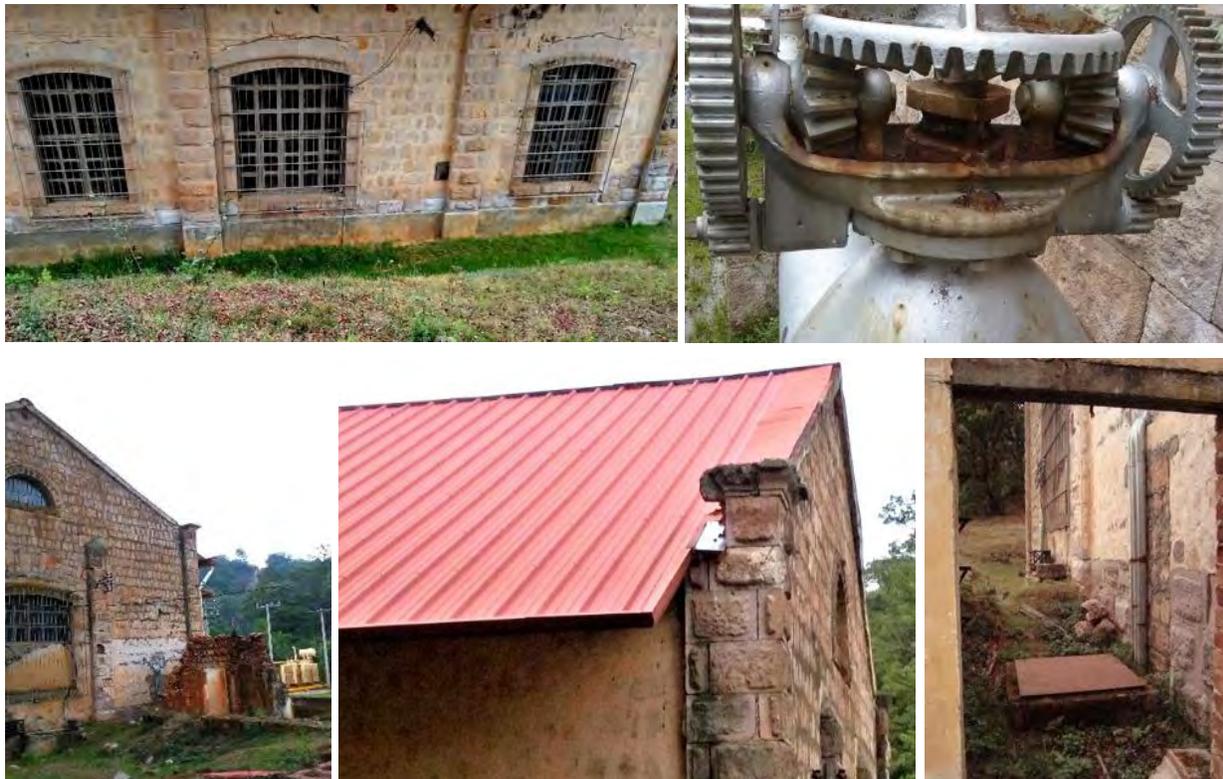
Deterioros de planta de luz hidroeléctrica, La Trinidad en 2017.
